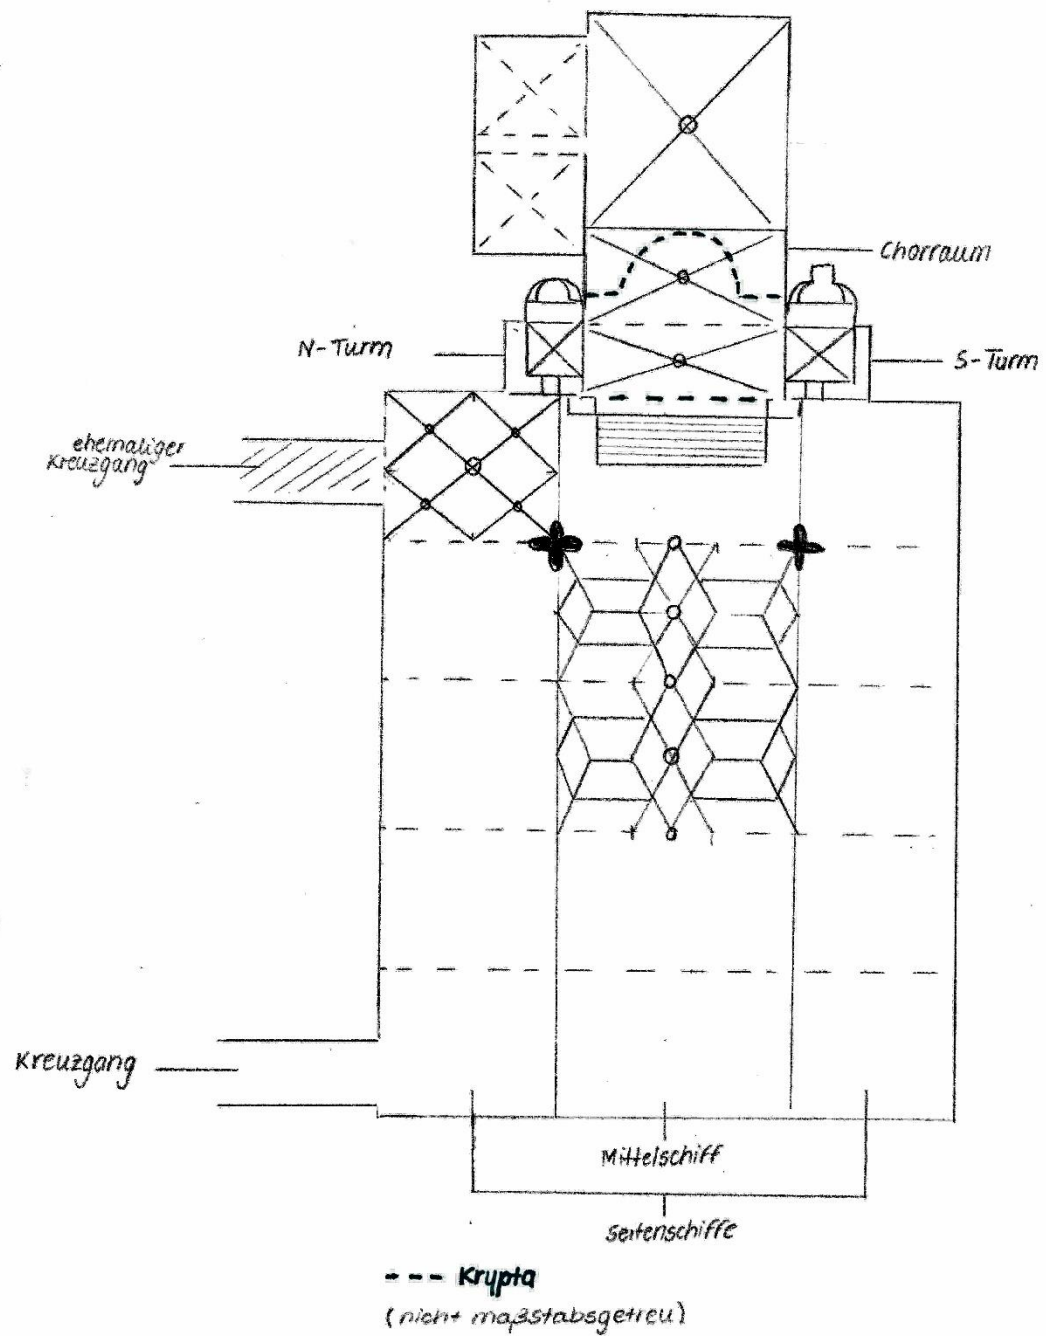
Grundriss des Domes zum Heiligen Kreuz Nordhausen
